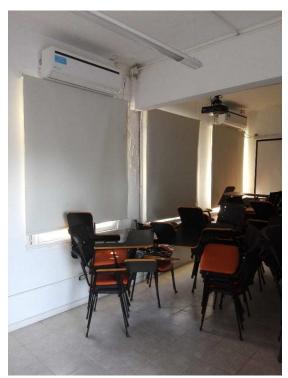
y 2: Aula, filtración sobre pared donde se encuentra la bajada pluvial
